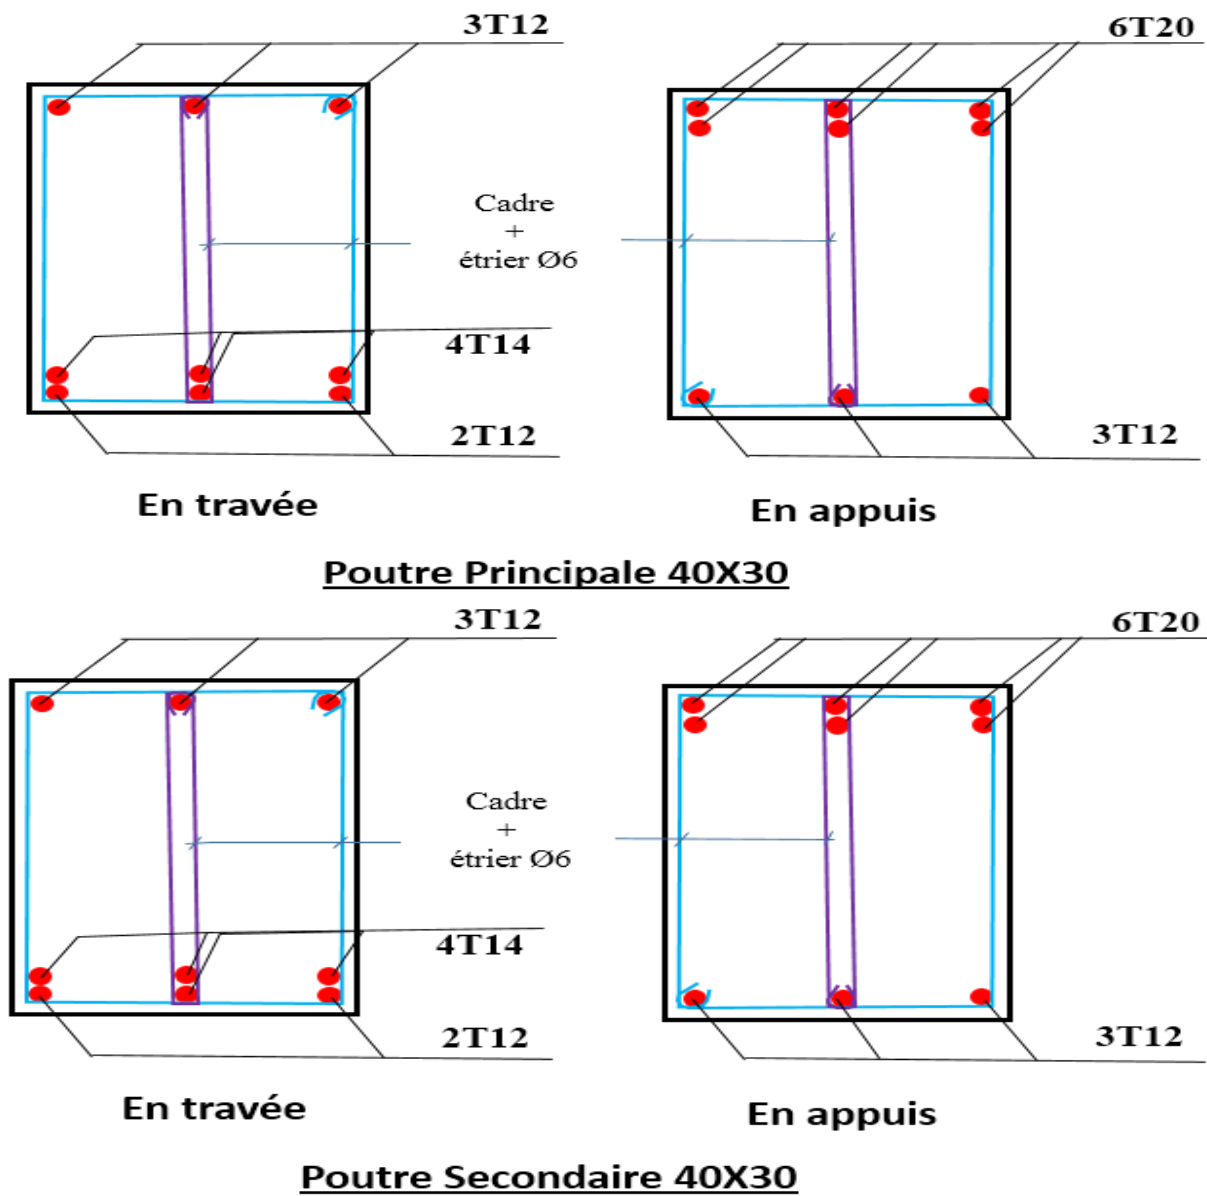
Dessin de ferrailage des poutre principales et secondaires
